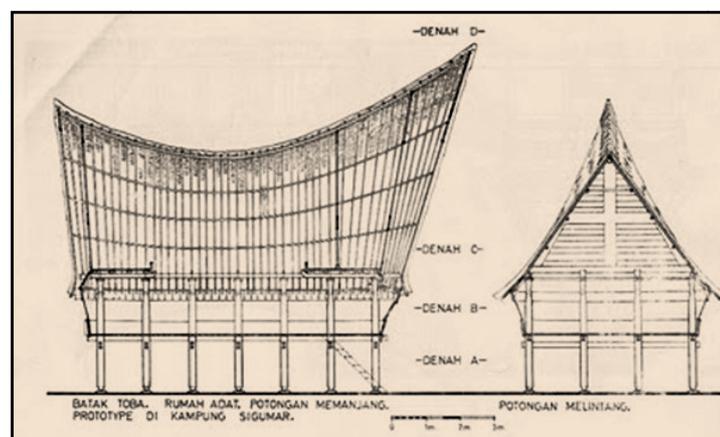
Plano de sección. Vivienda tradicional en Sumatra (Indonesia)
